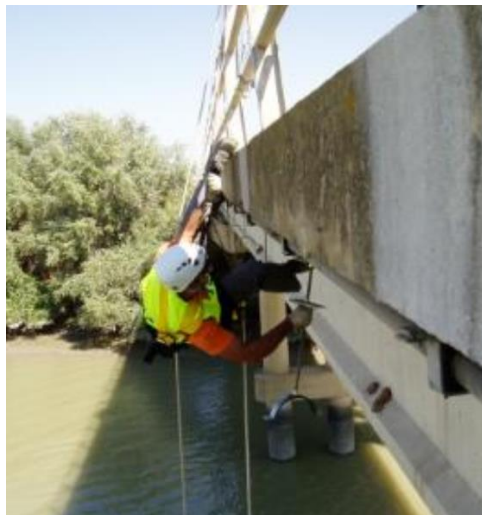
PERFORACIÓN PARA COLOCACIÓN DE TAQUETES PARA ADOSAMIENTO A PUENTE.
